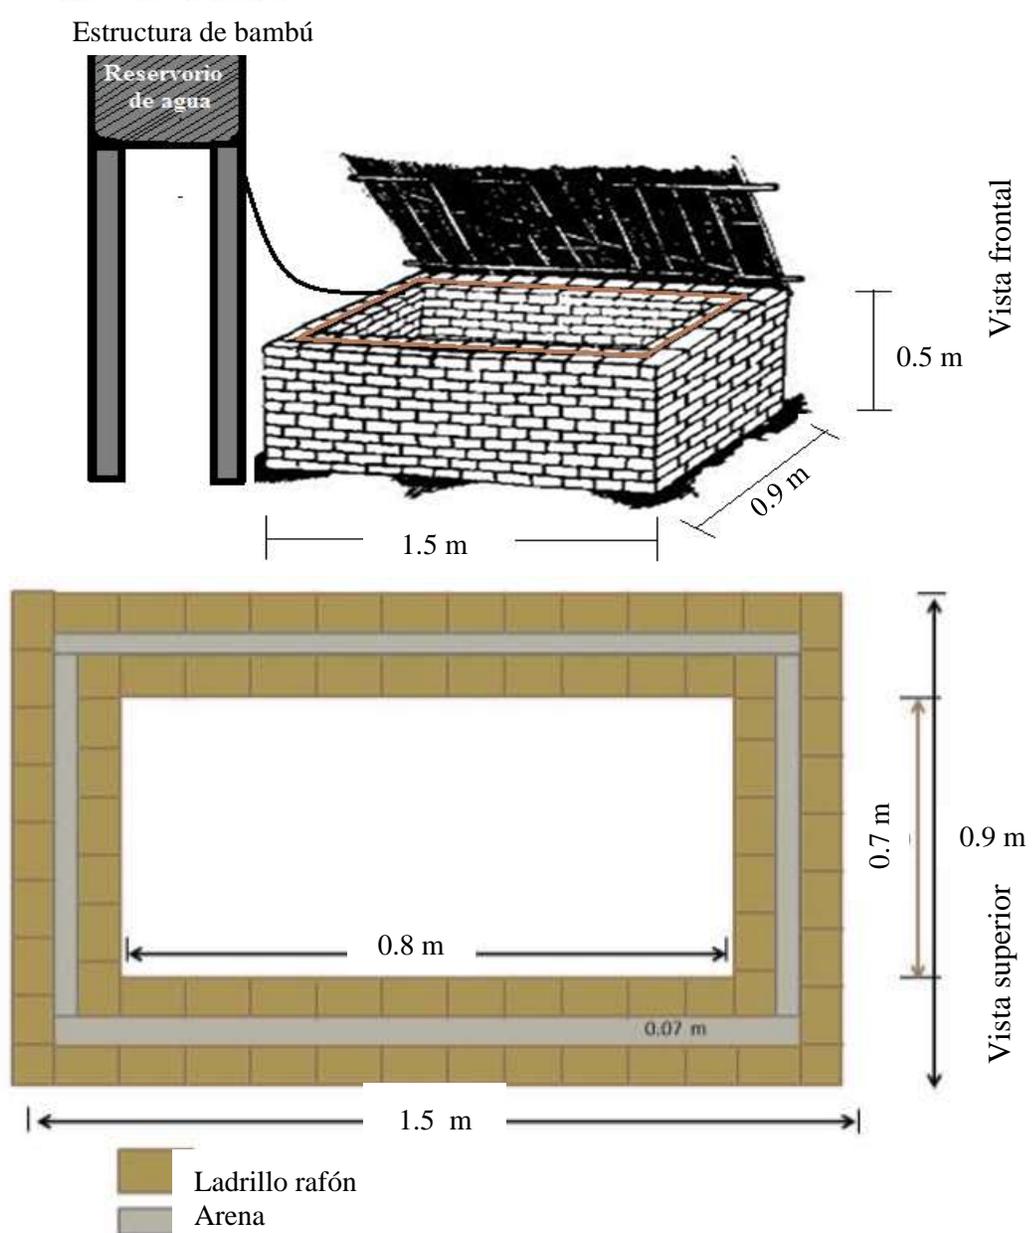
Plano modelo para la construcción de la cámara ZECC.
